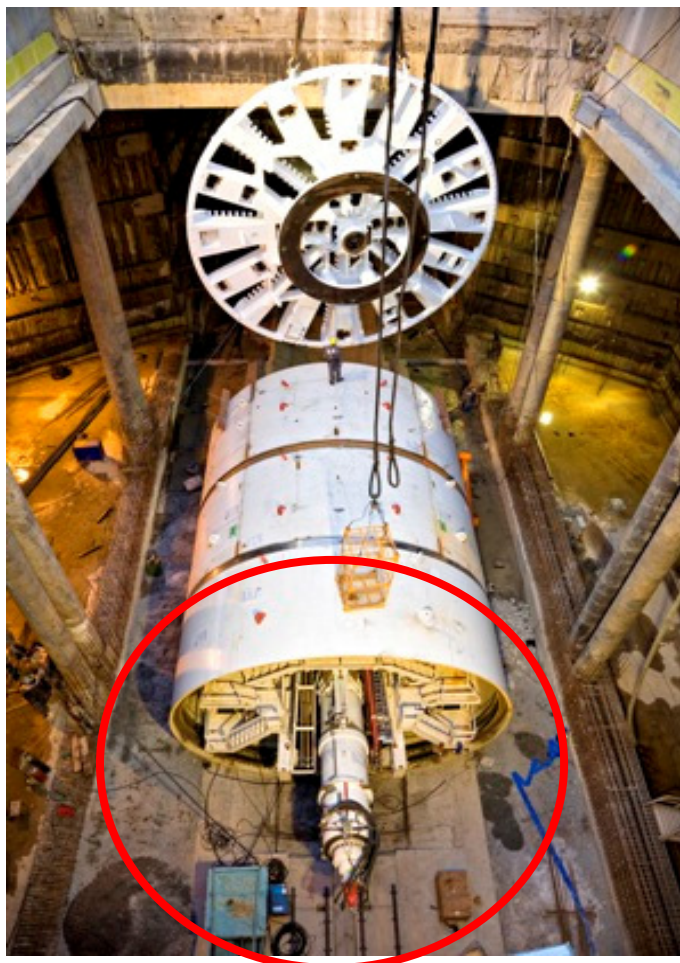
Parte traseira do shield que saiu primeiro na desmontagem
